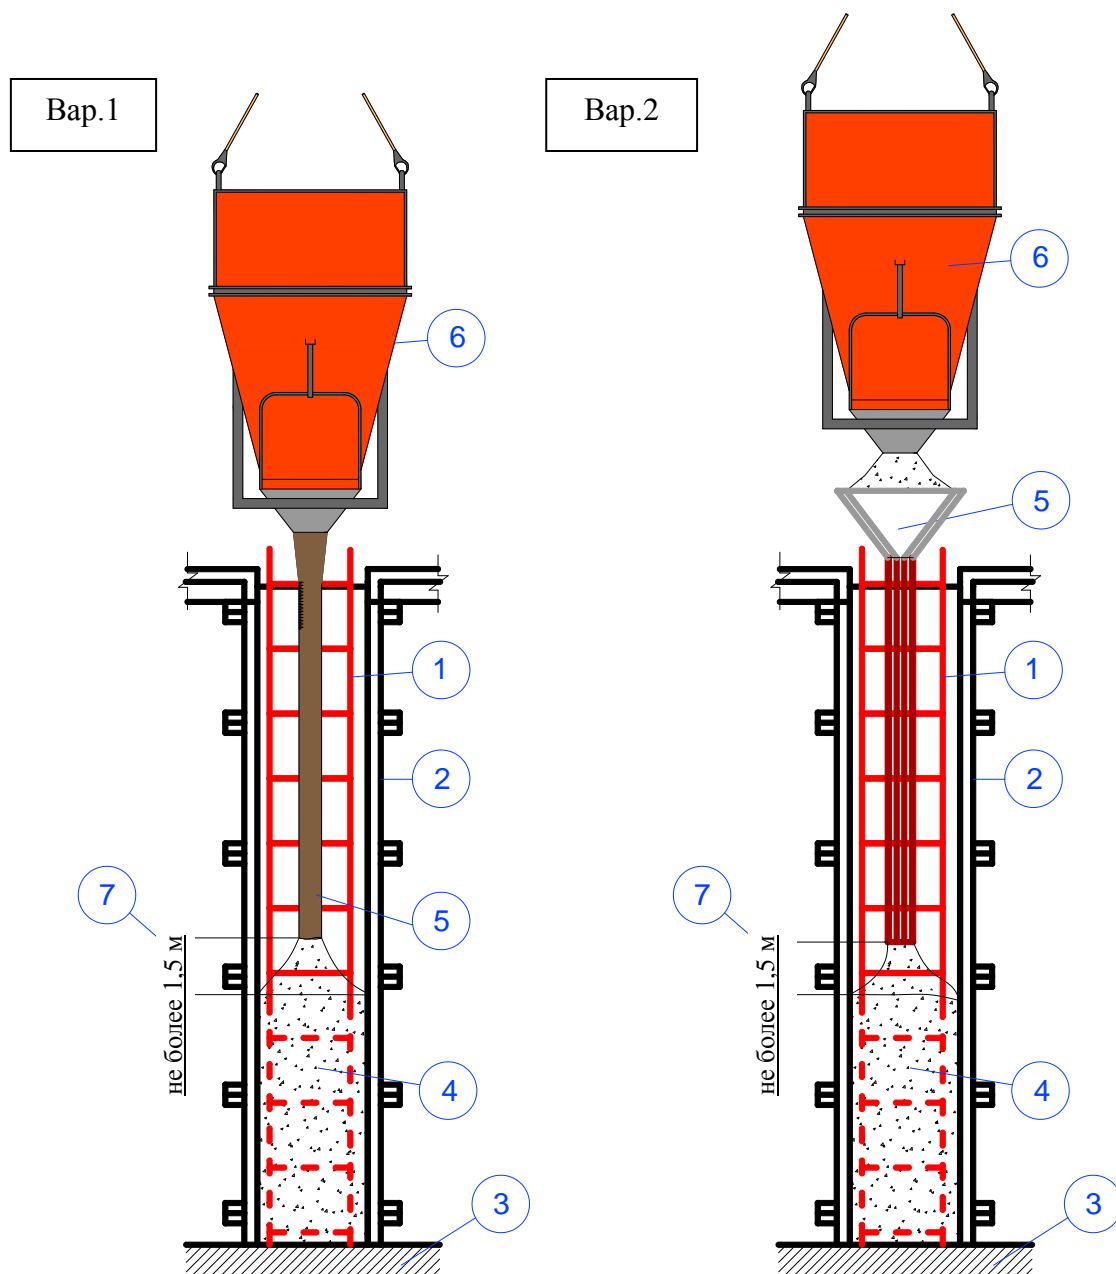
Схемы подачи бетонной смеси в конструкции стен:
